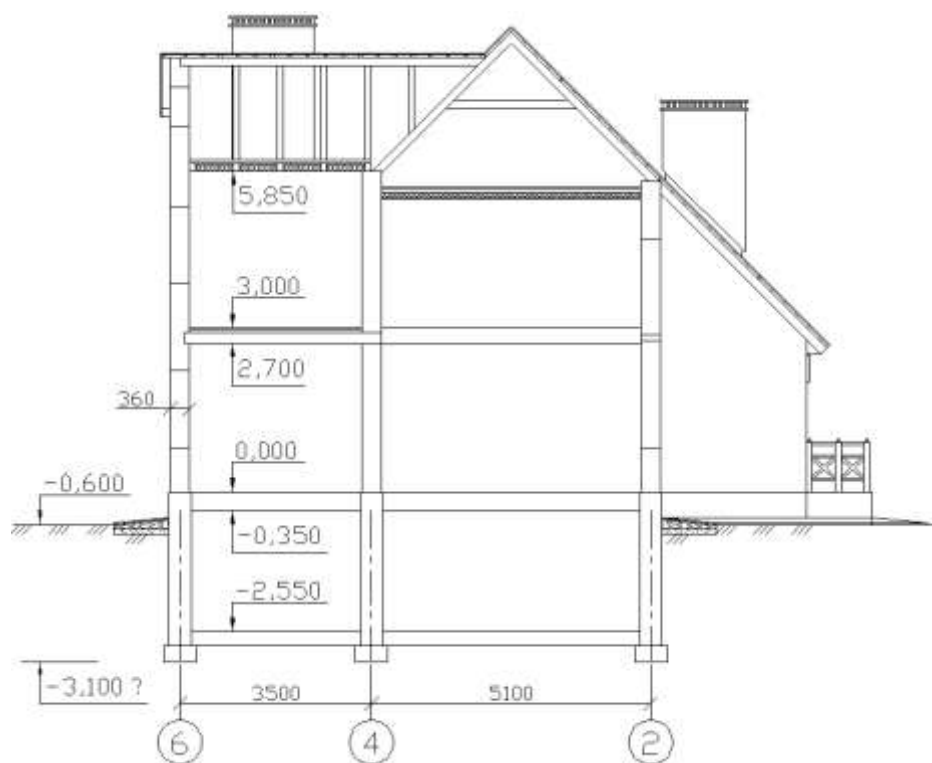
Схема будівлі по осям 2 – 4 – 6
